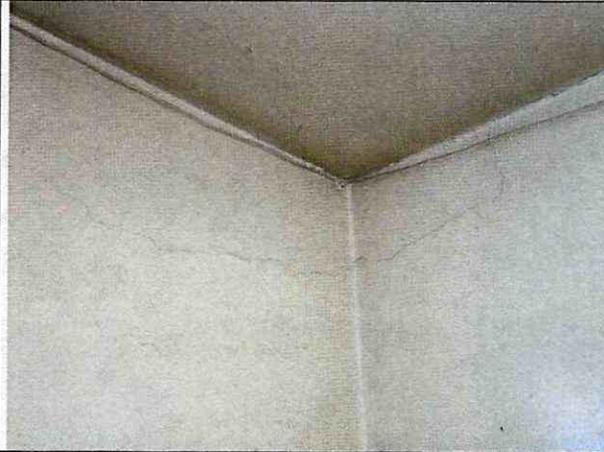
Grieta en parte alta del muro, altillo.
